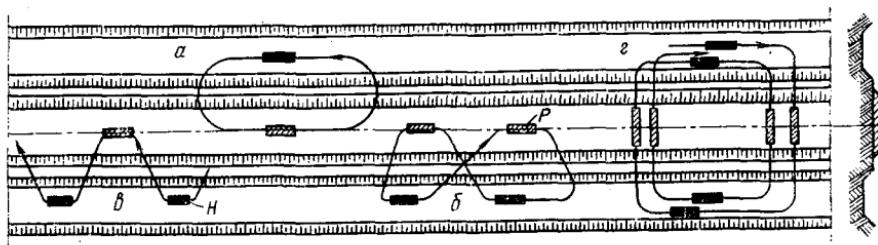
Схемы движения скреперов при возведении насыпей из боковых резервов:
